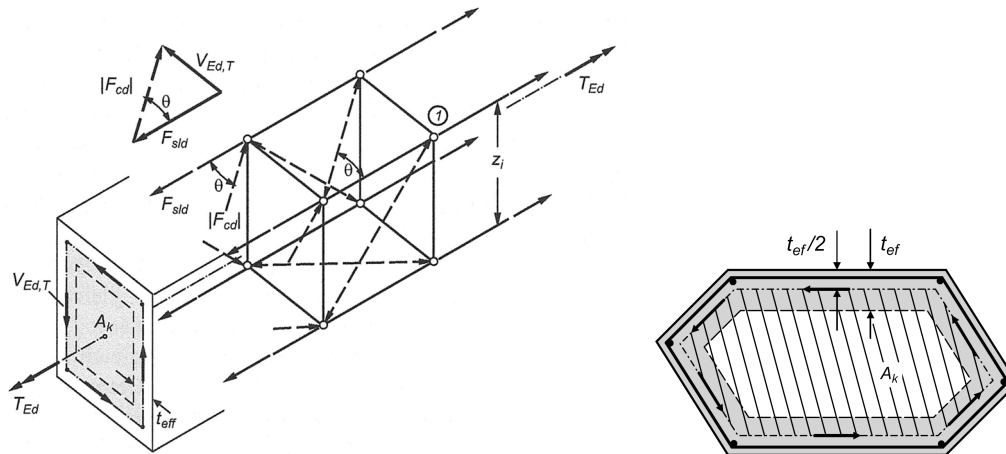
Räumliches Fachwerkmodell bei Torsionsbeanspruchung aus [116]
